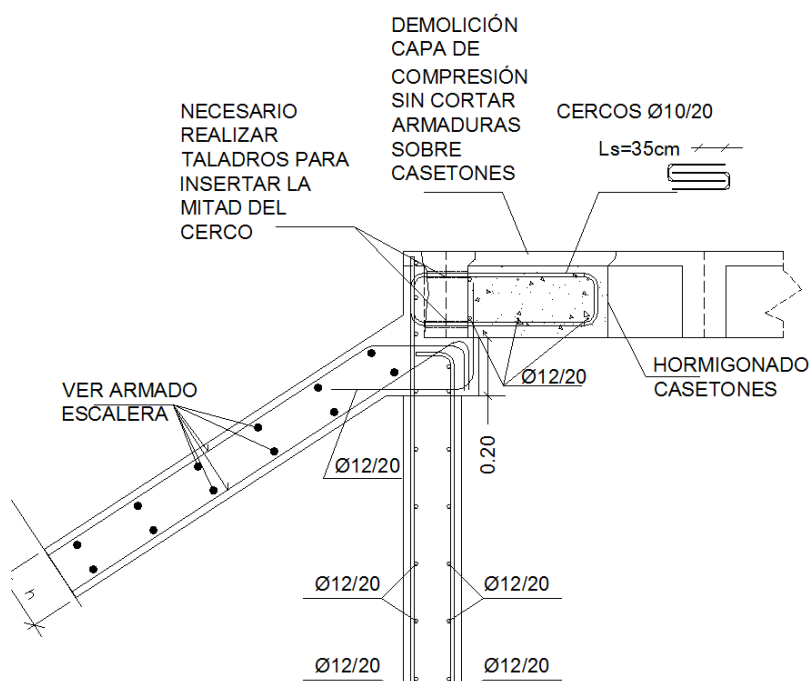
Detalle del refuerzo proyectado en el apoyo de la escalera.
